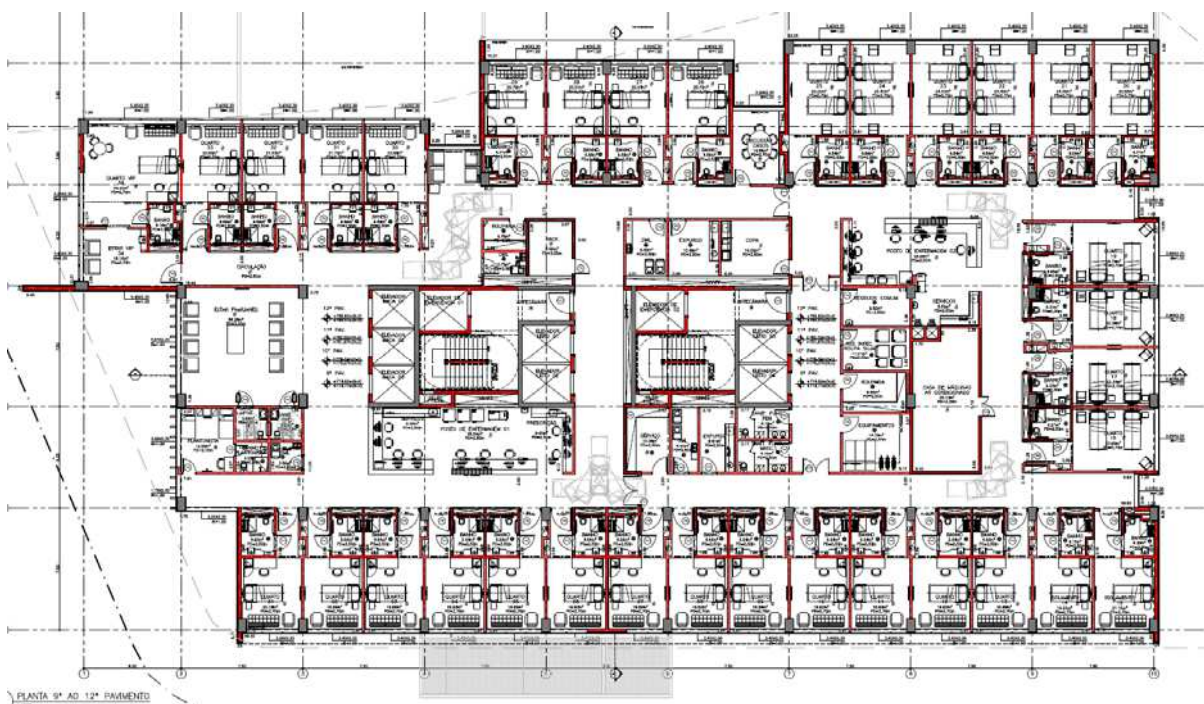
Planta do 9º ao 12º Pavimentos – leitos de internação.
